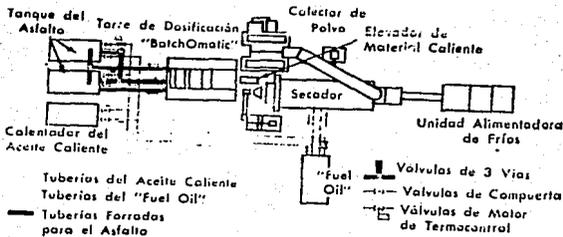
Plan típico de una planta intermitente y distribución de las Tuberías.
